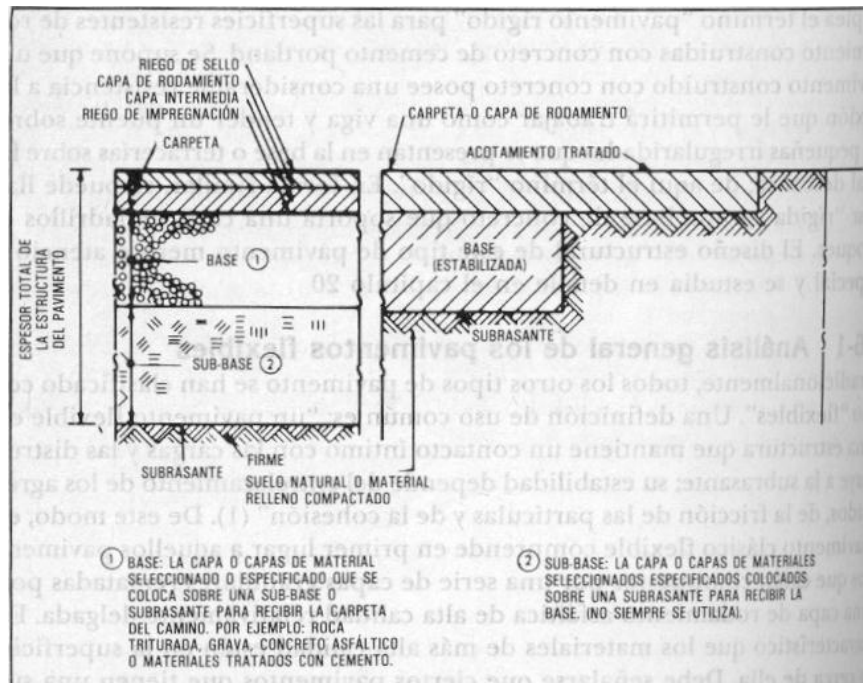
Estructura de un pavimento flexible y un pavimento rígido.
